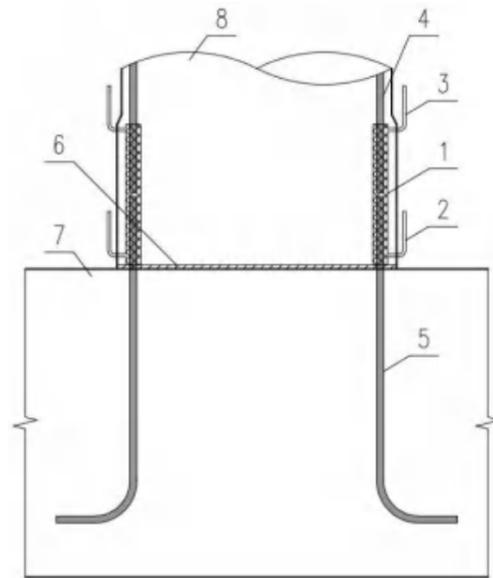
墩柱与承台钢筋灌浆套筒连接典型构造示意图
